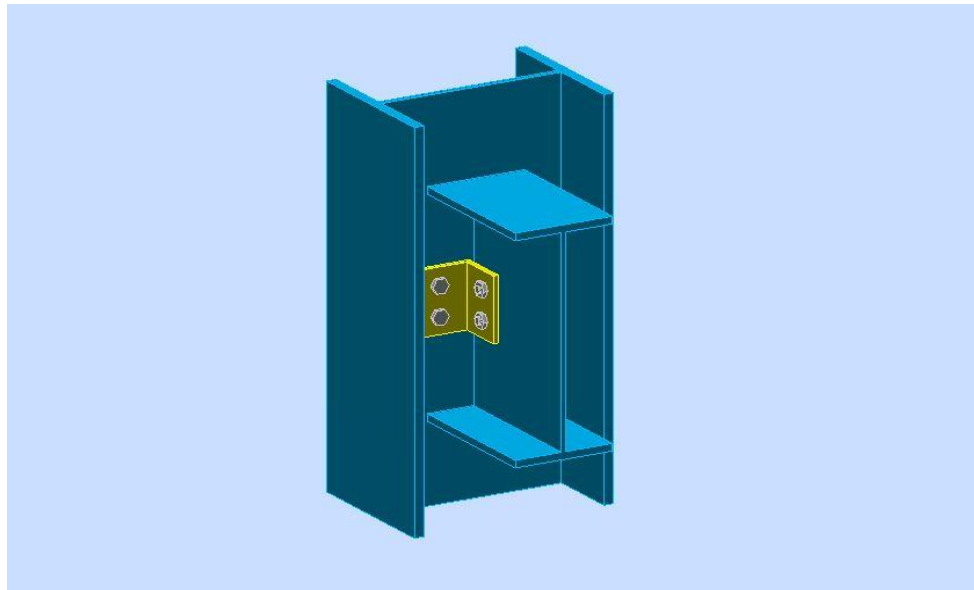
Vue 3D de l'assemblage poteau poutre (âme).
